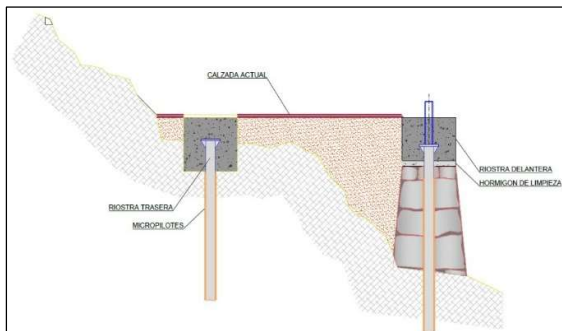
Sección tipo fase constructiva viga riostra trasera.
